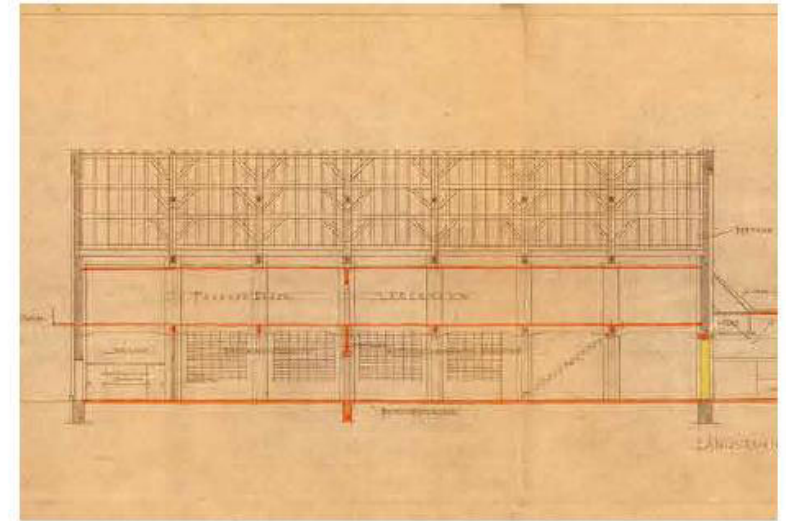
Plan für den Umbau (1927). Architekt: Walter Hämer. Längsschnitt, Blick auf Nordwand. Darstellung der bauzeitlichen Dachkonstruktion. Einbau einer Zwischendecke aus Beton, Anschluss der Adler-Halle rechts (Bd. 05/019)
